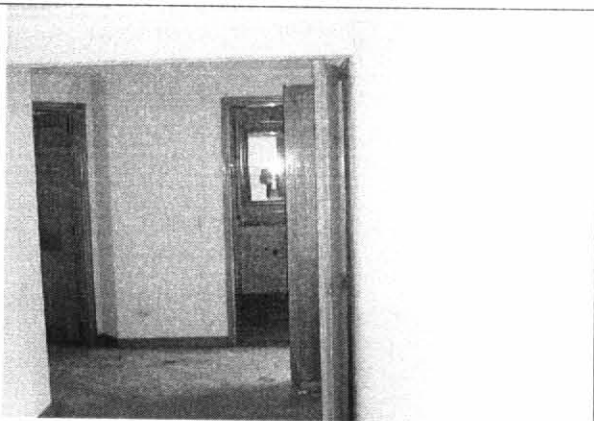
En los apartamentos ubicados a partir del piso dos(2) no se identifican daños estructurales.
